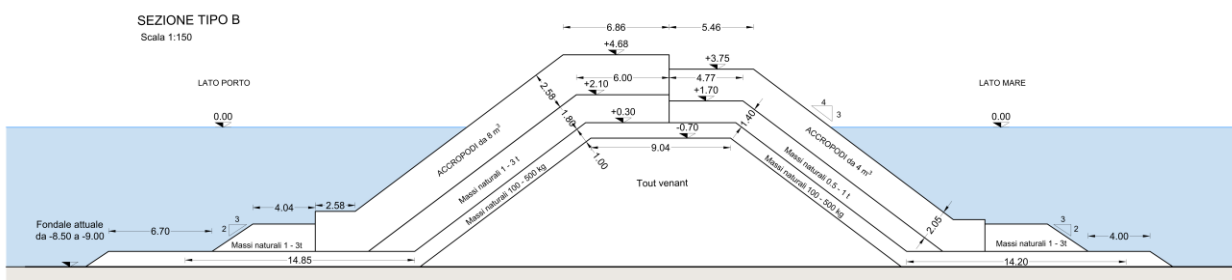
Sezione tipo B del Prolungamento della Diga Foranea Sud
